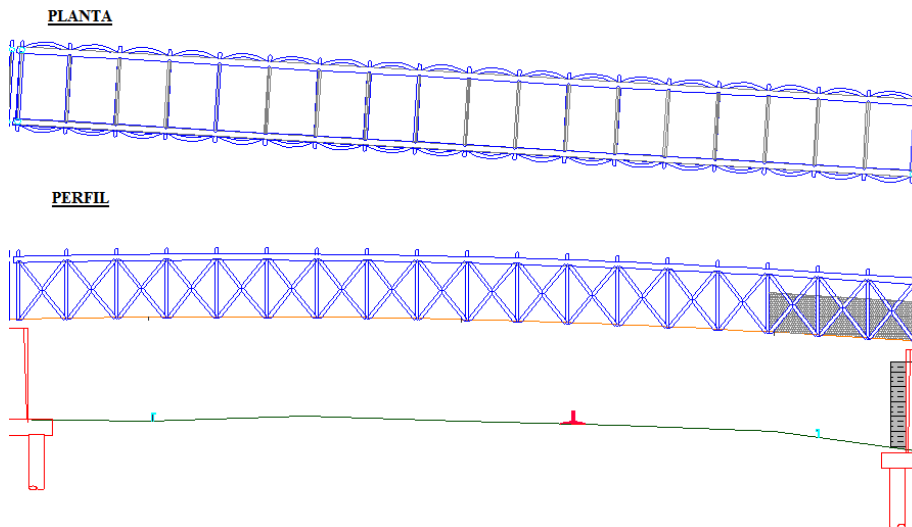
Vista en planta y perfil del vano central de la pasarela de Tablada sobre la SE-30. Fuente: Acciona.
